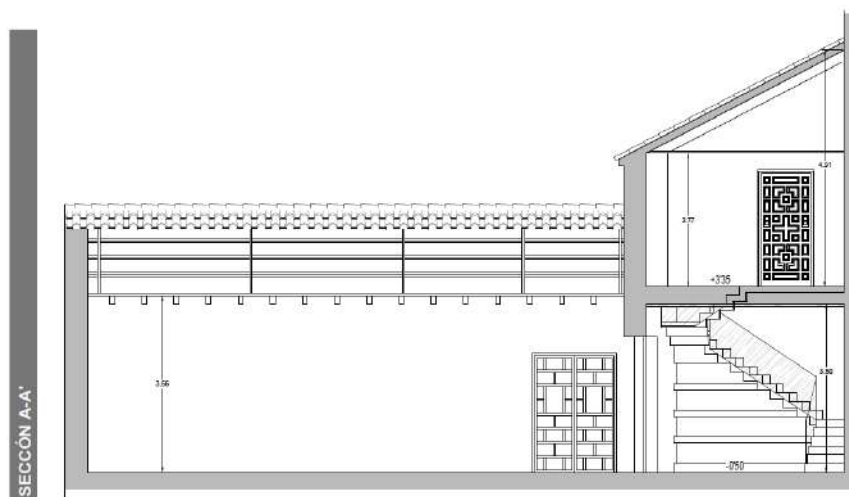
Alzado de la zona de intervención para despacho parroquial y archivo. (Fuente: M^a Auxiliadora Portero).
